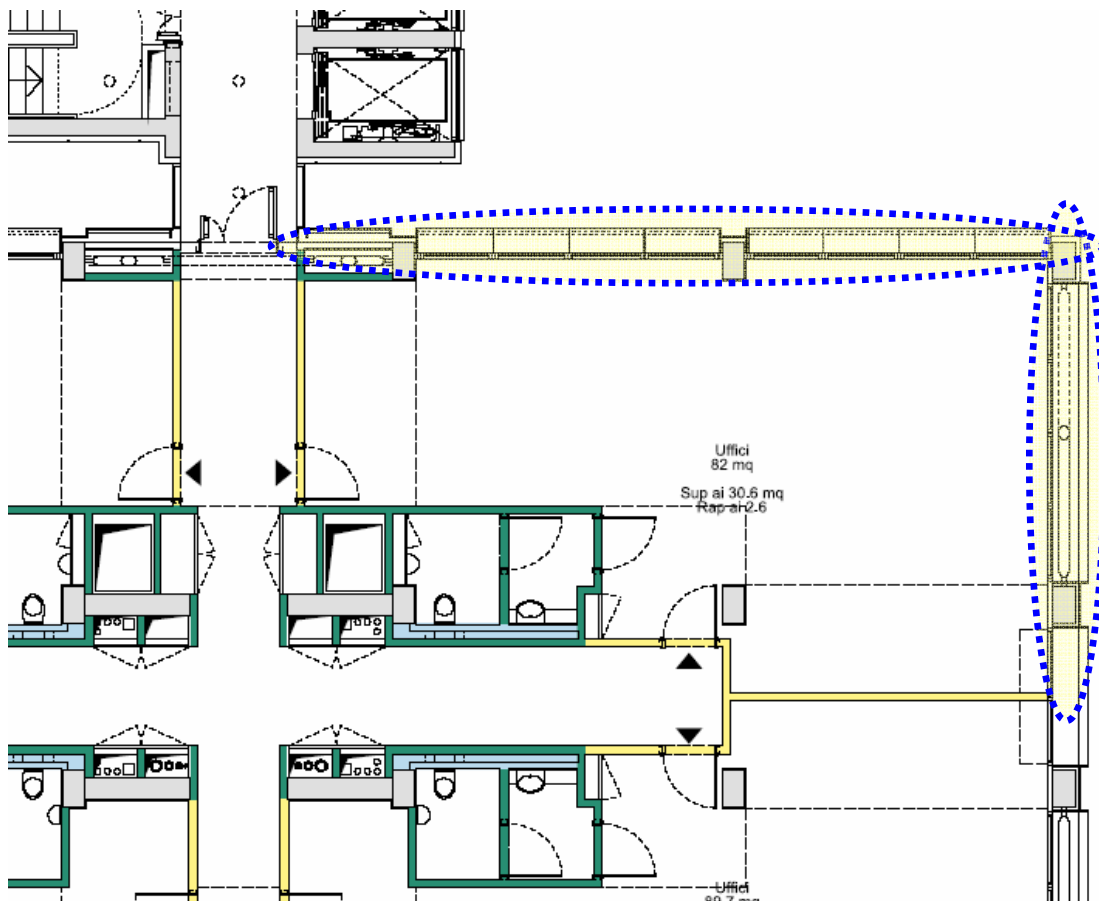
Indicazione in pianta della facciata oggetto di valutazione
